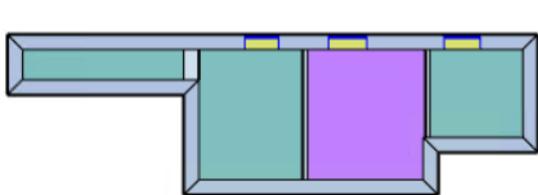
Grundriss Kellergeschoss, zoniert
